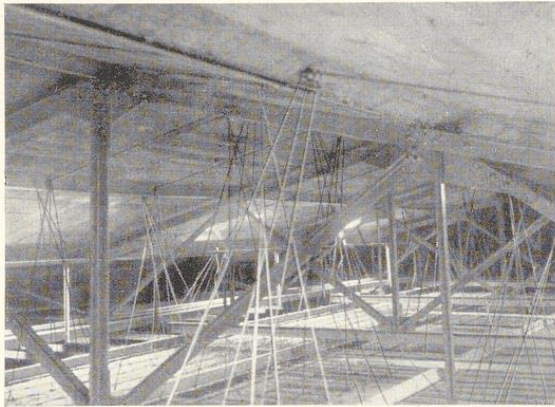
Strahlenförmige Abhängung einer Rabitzdecke an den eisernen Trägern eines Betondaches
